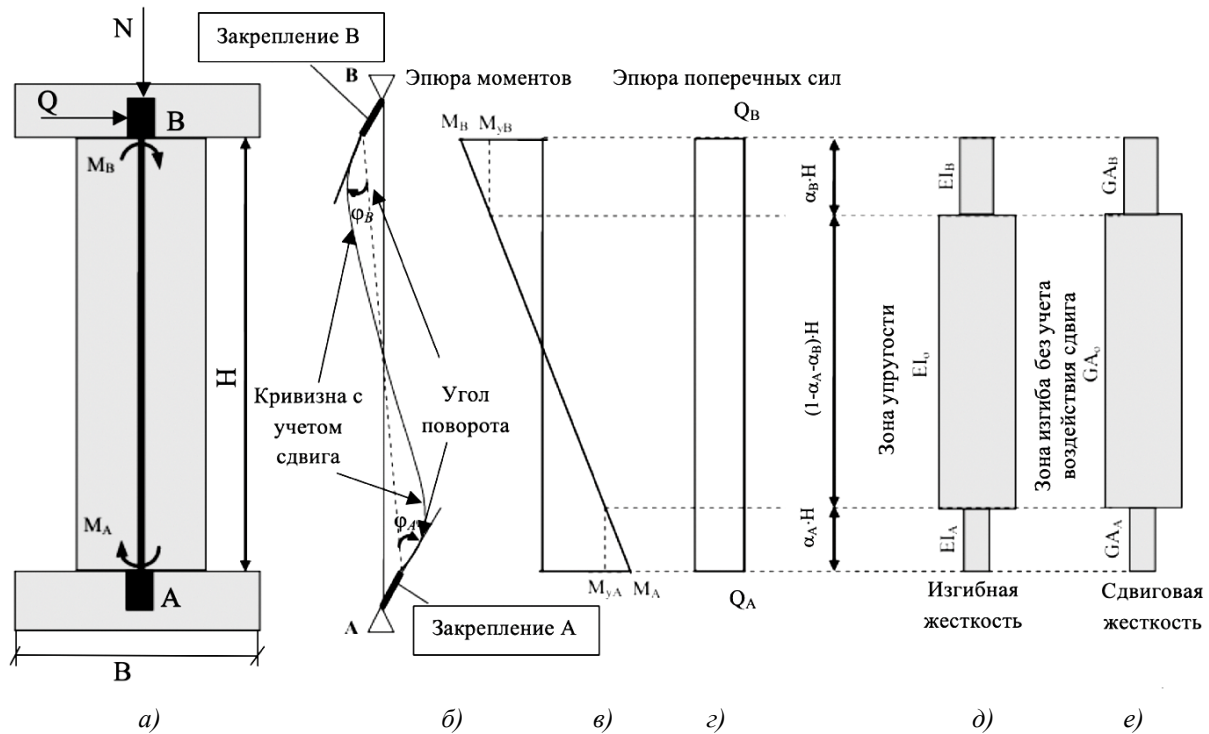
Стержневая расчетная схема деформирования железобетонной стены при совместном действии вертикальной N и горизонтальной Q нагрузки: а — стержневая модель расчета стены; б — схема искривления продольной оси стержня при деформировании; в — эпюра моментов; г — эпюра поперечных сил; д — схема моделирования изгиба стены; е — схема моделирования стены с учетом взаимодействия сдвига и изгиба [9]
